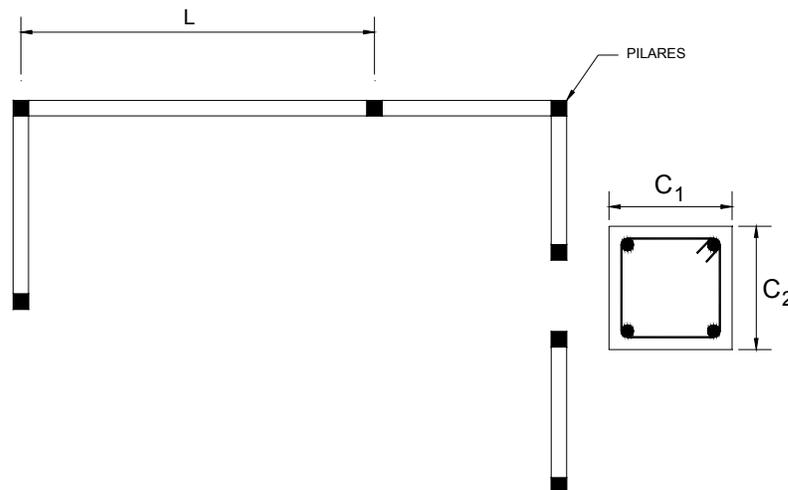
PILARES DE CONFINAMIENTO
